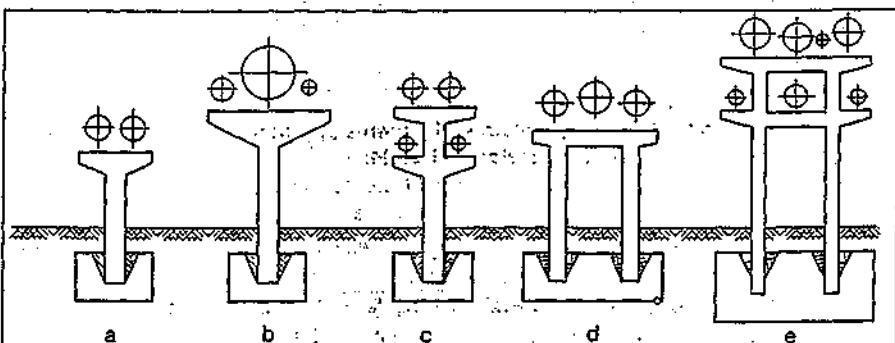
Amplasarea aeriană a conductelor termice pe stâlpi prefabricați din beton armat:
